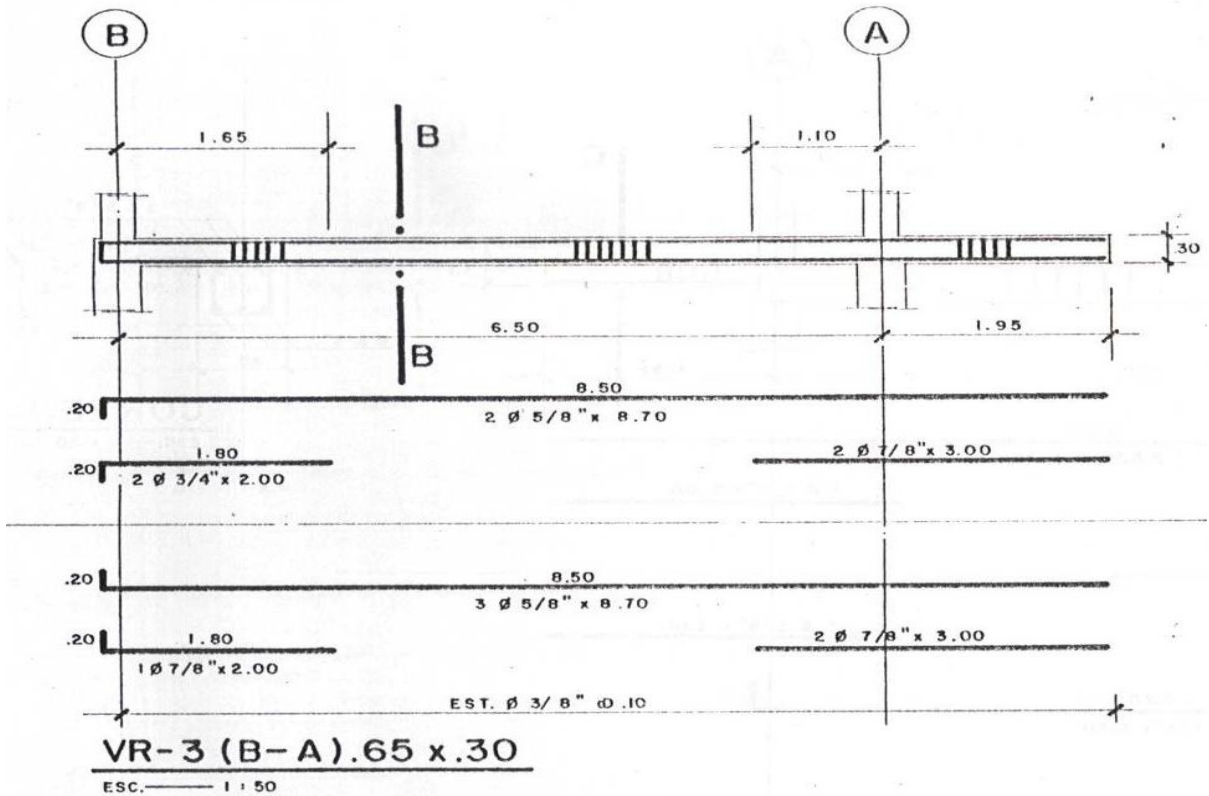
Detalles de viga VR-3. Modulo de Barrio.
